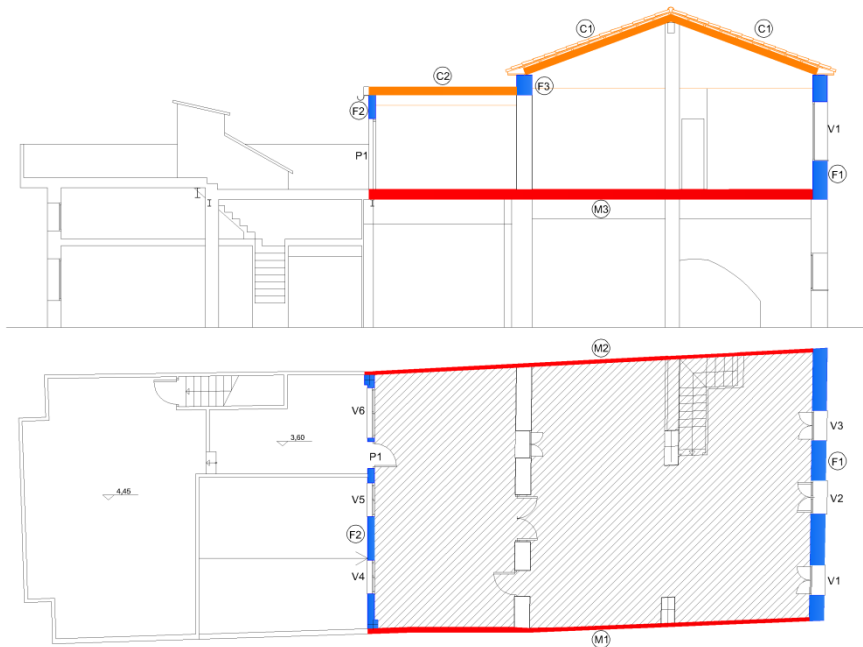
Envolvente de la vivienda de la planta primera. 2014.
